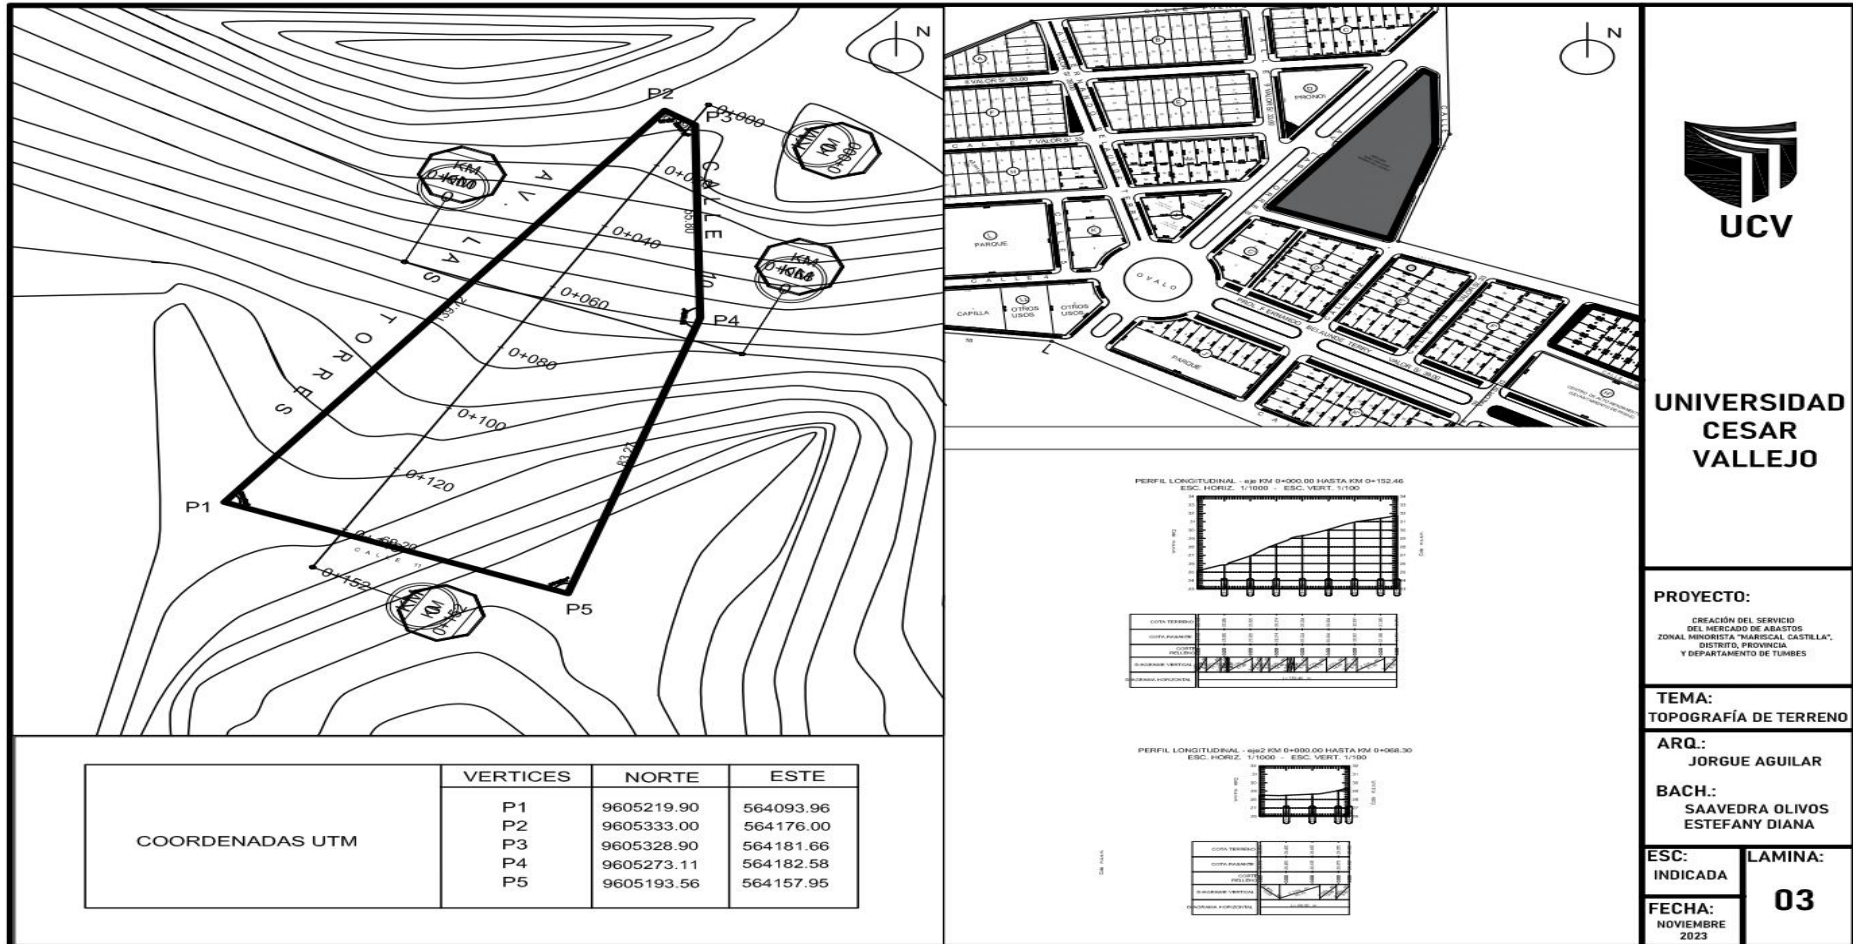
Plano de parámetro. Fuente: Elaboración propia.
